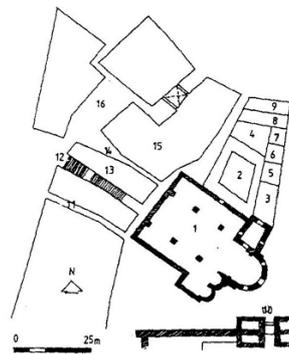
Planimetría de Sant Feliu. S. XII. (Canals et alii, 1998:37)
